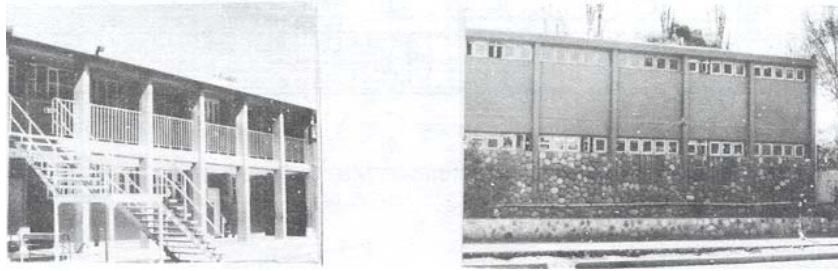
Situación de Referencia: Fachadas Norte y Sur.
